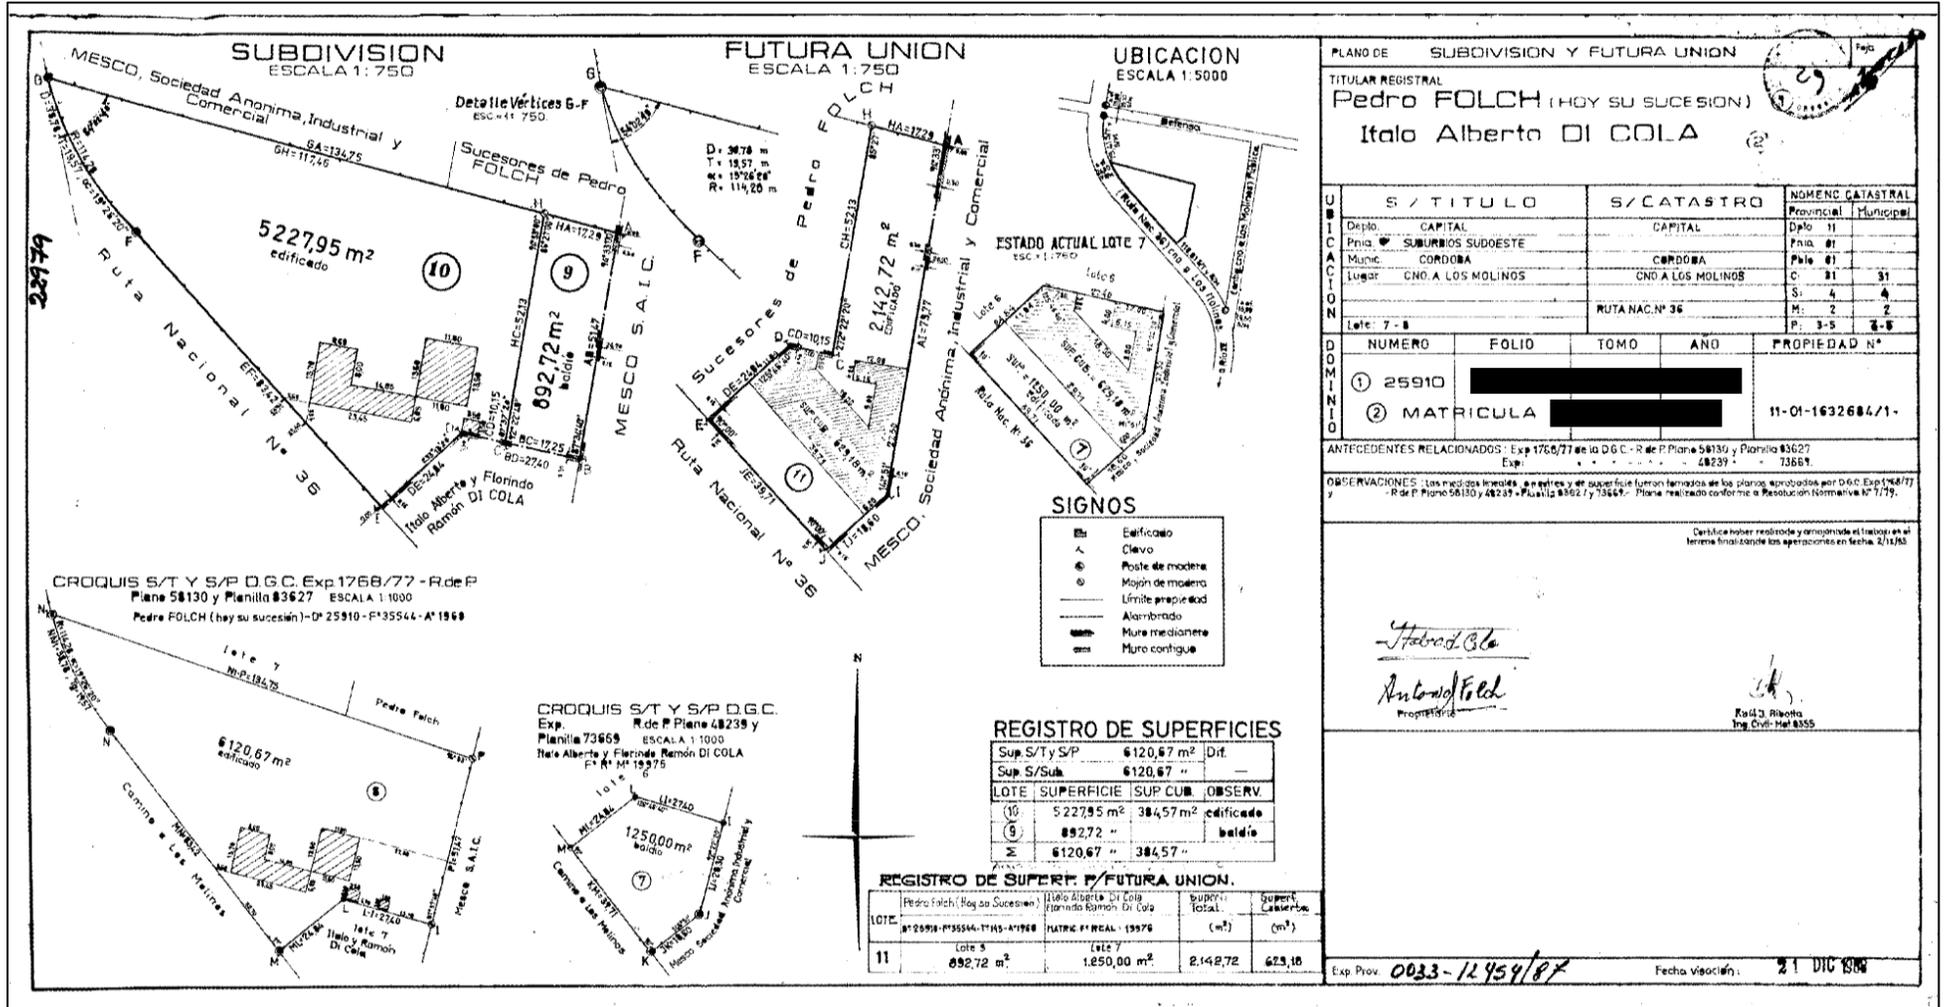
plano de subdivisión y futura unión de las parcelas 31-04-002-004 y 31-04-002-009.<sup>1</sup>
